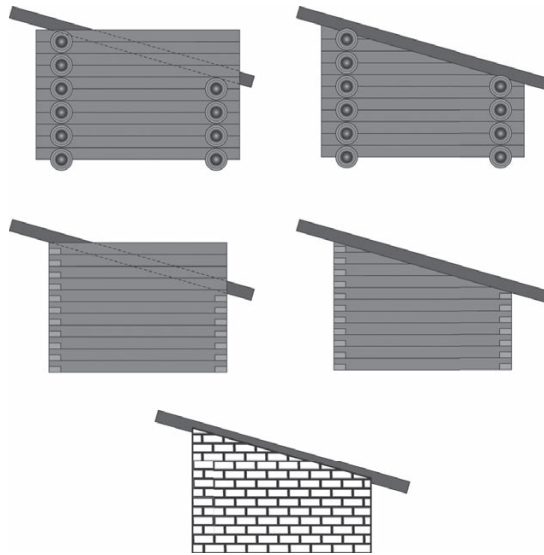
Перекрытие под кровлю с опорой на две несущие стены
